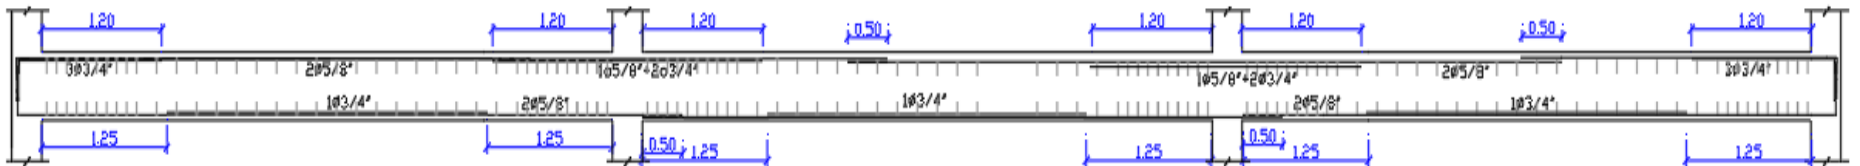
Vista elevación del detalle de refuerzo de la viga V-T07 en el 2° nivel.
